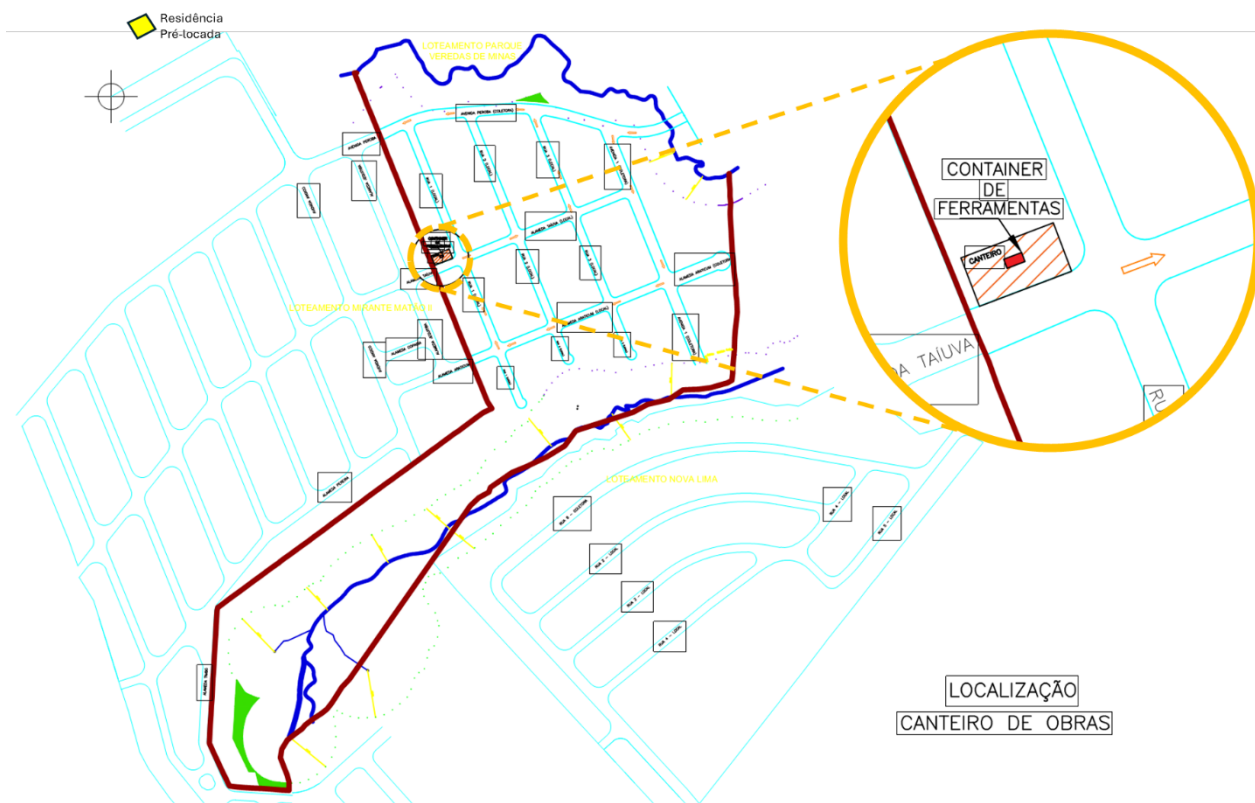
Projeto urbanístico com a indicação do local proposto para instalação do canteiro de obras.
